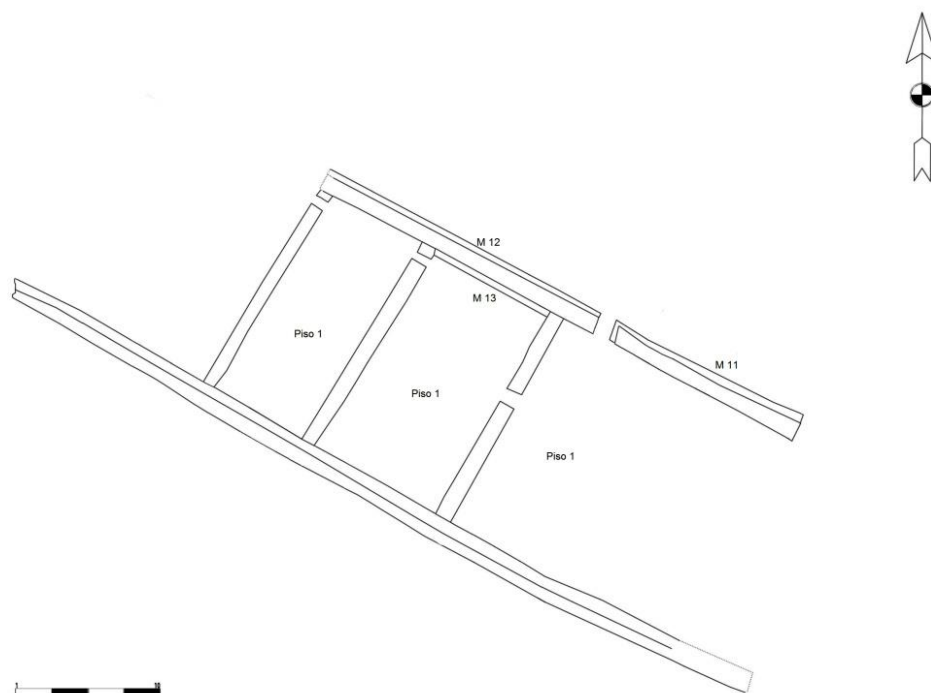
(2).- Fase constructiva 3: planta
